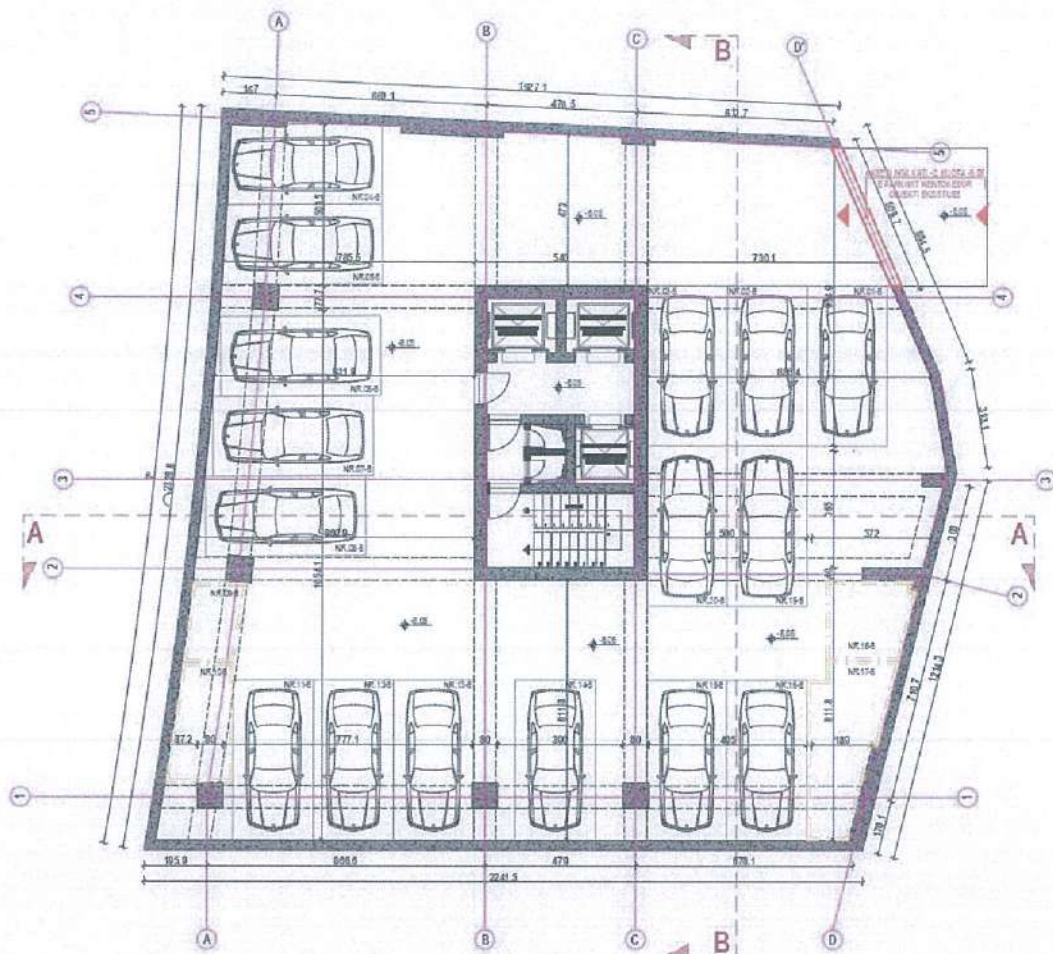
Planimetria e kateve nëntokë (-4)
